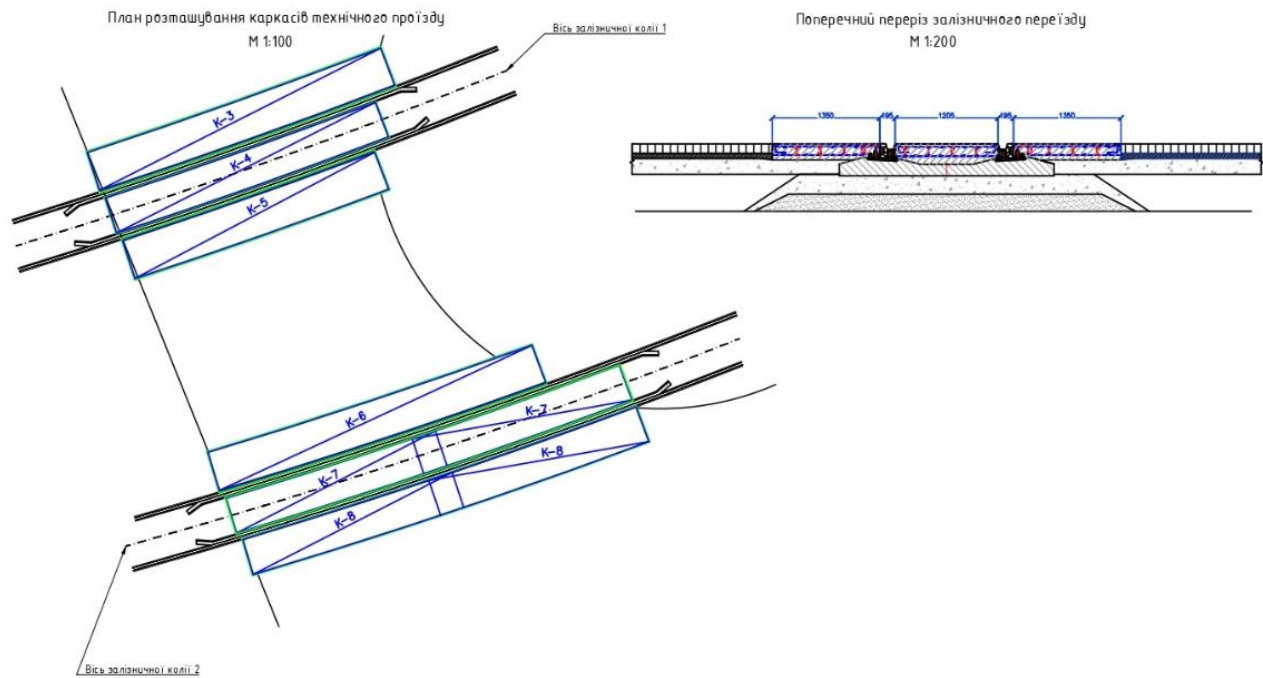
План та поперечний переріз монолітної залізобетонної плити
